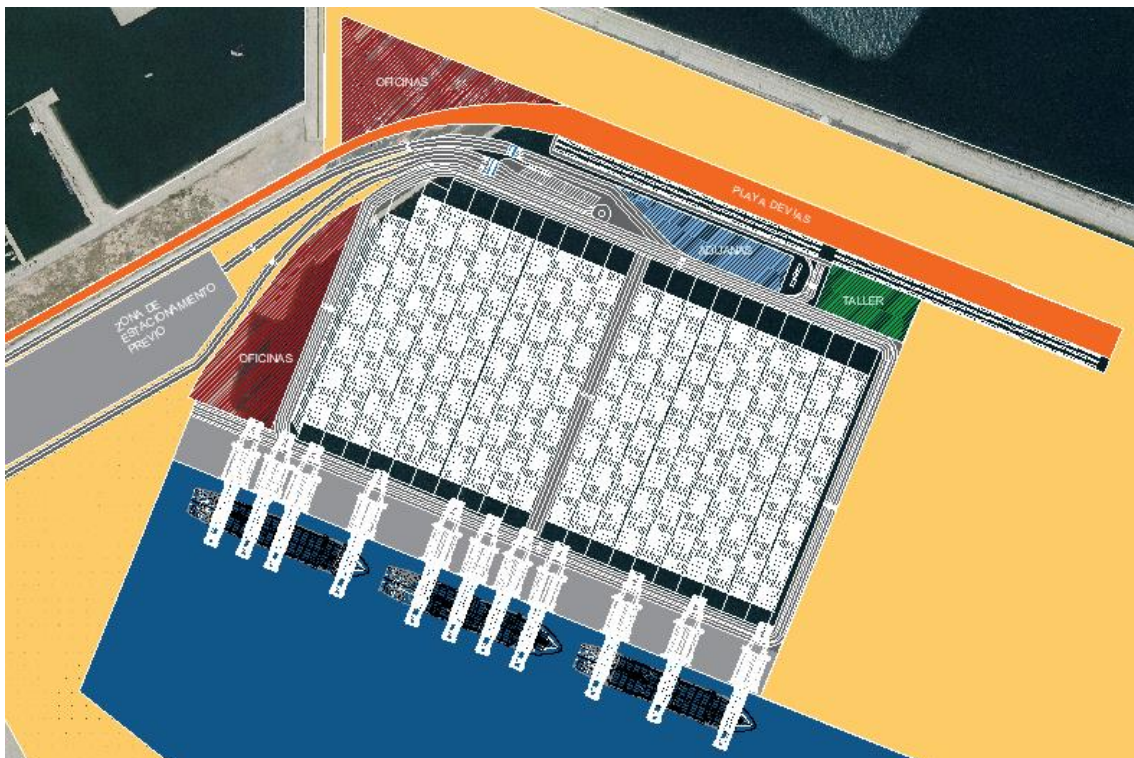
Plano de la entrada terrestre a la terminal de la propuesta 1.
